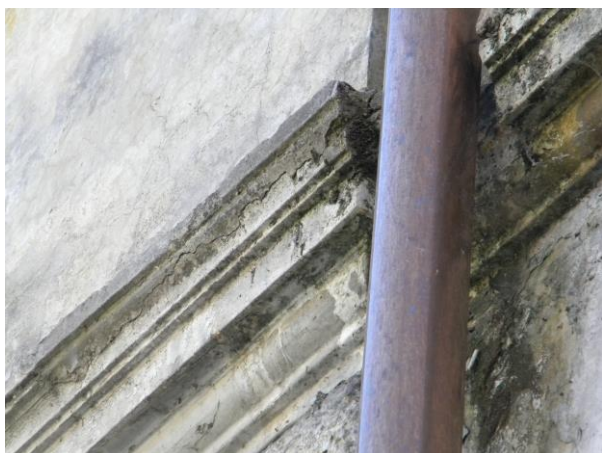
Facciata nord – perdita di materiale dell'apparato decorativo
